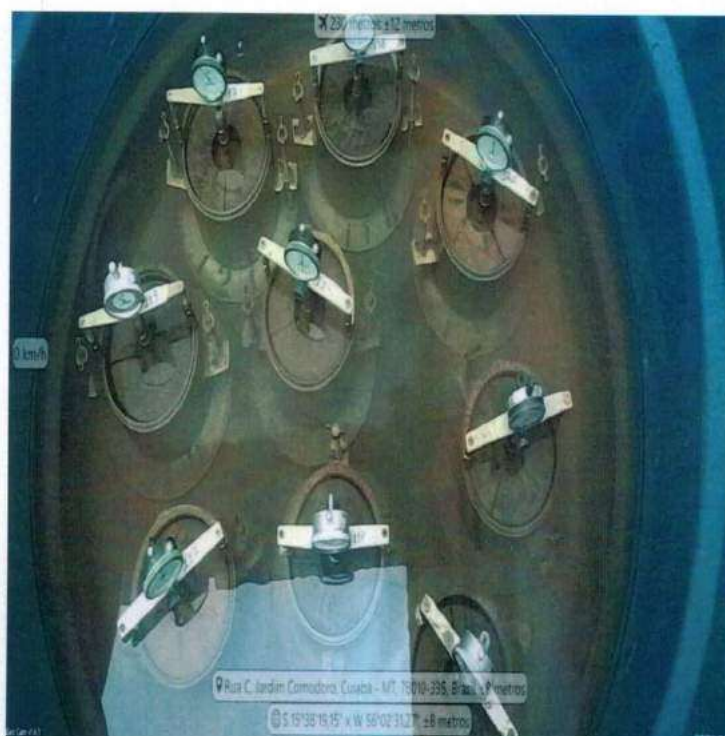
ENSAIO DE EXPANSÃO E IMERSÃO PARA CBR.
